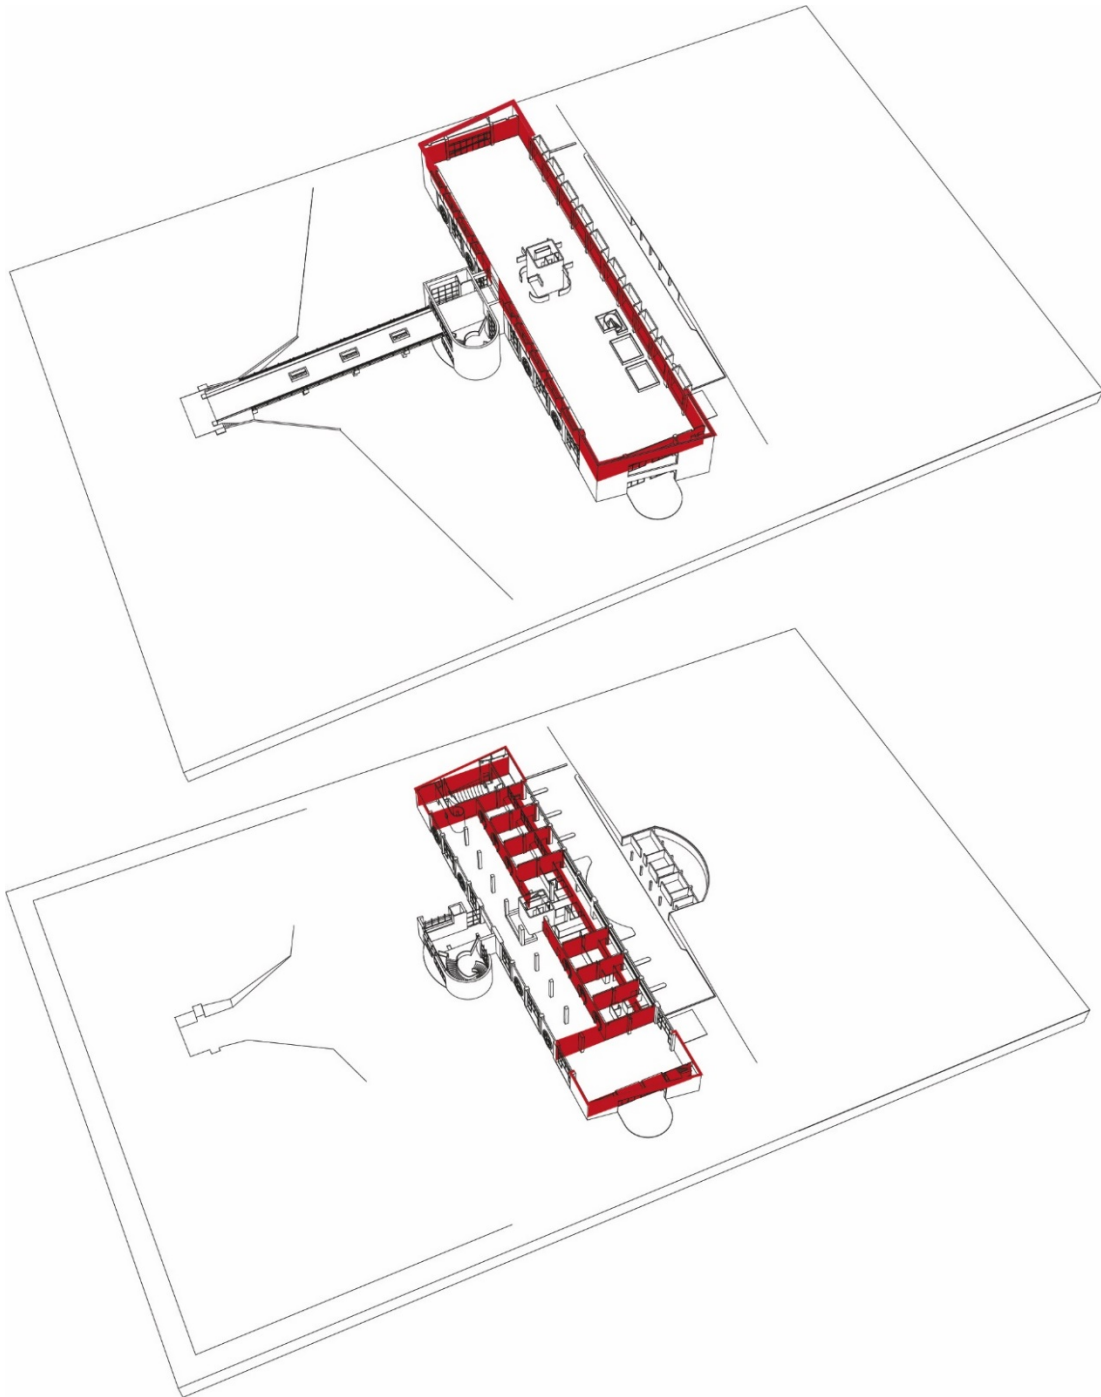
Figura II. Esquema organización espacios en planta alta y en planta baja. Fuente: el autor.
